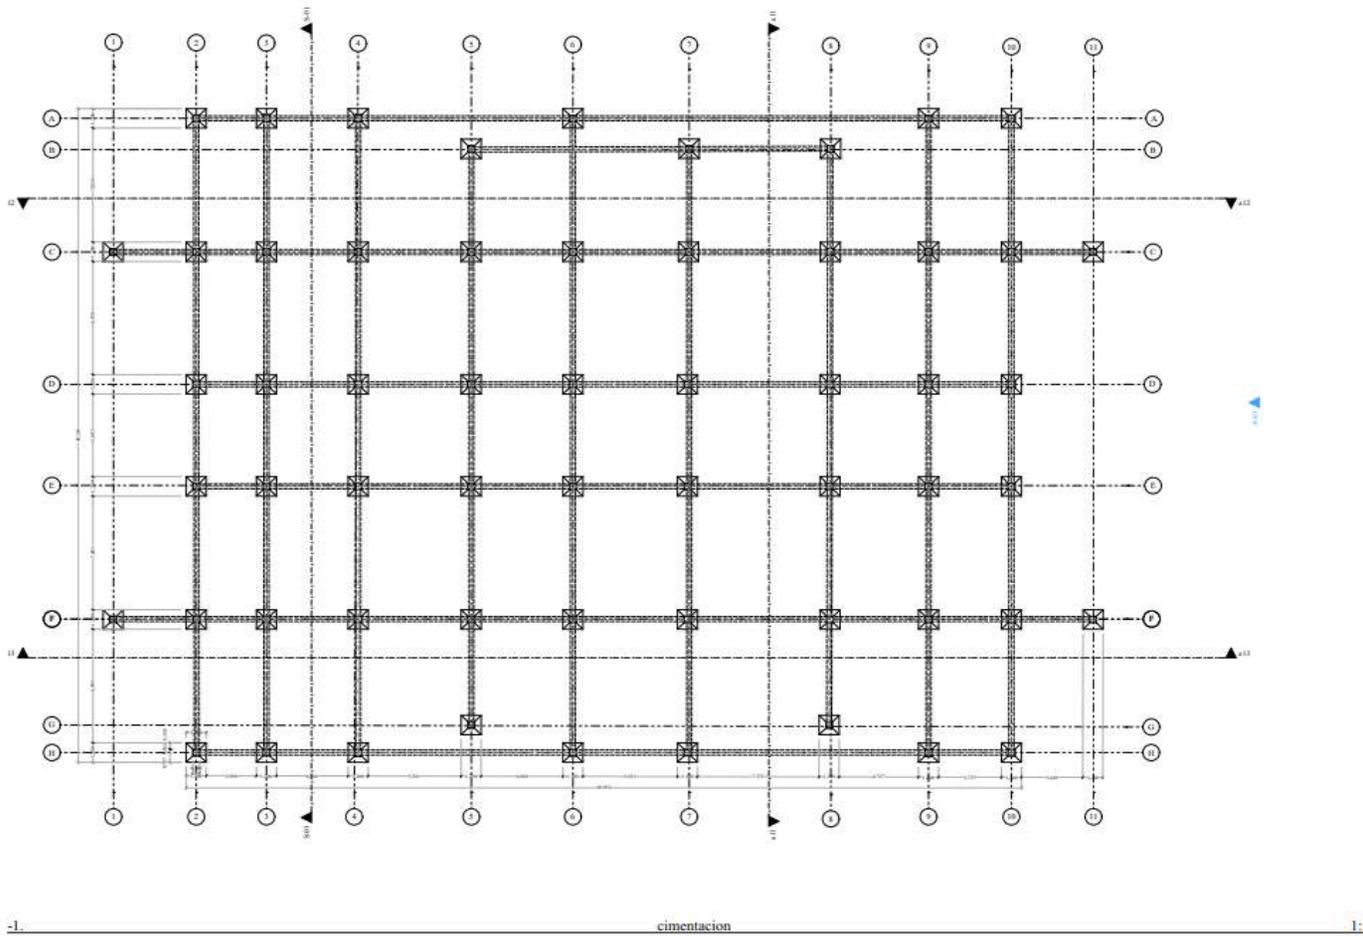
cortes plantas y estructural CAI. Fuente: elaboración propia
